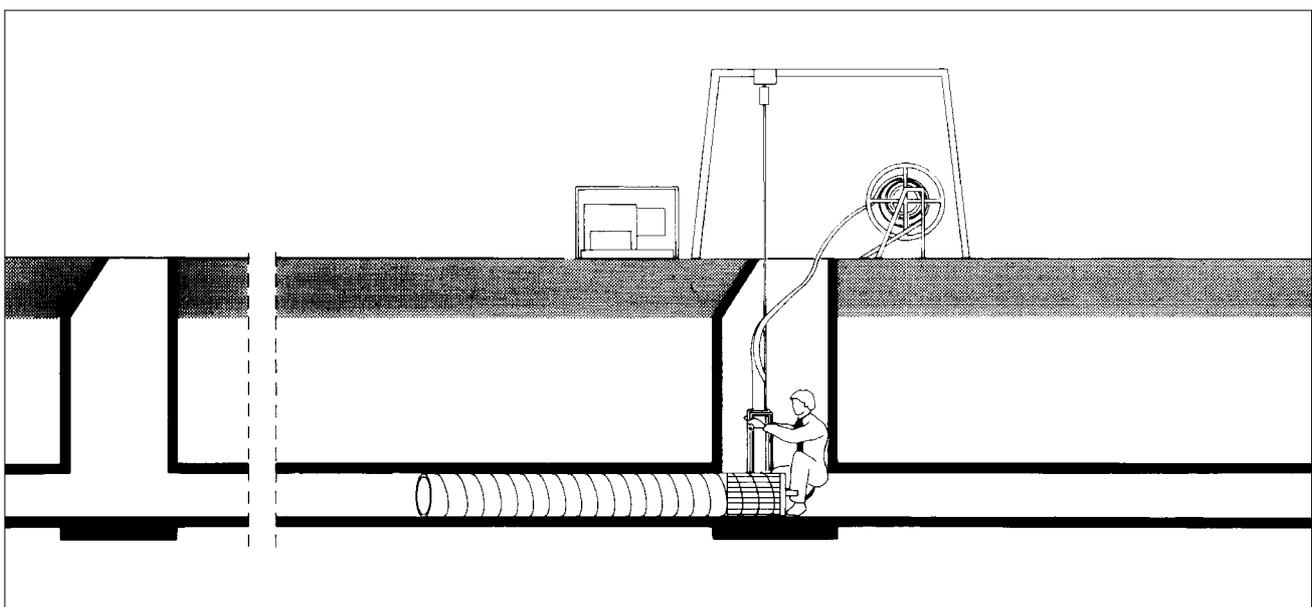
Enroulement et poussage du tube spirale pour le chemisage par tube spirale.
